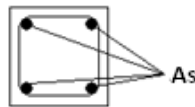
Sección transversal de columna (Elaboración Propia)
